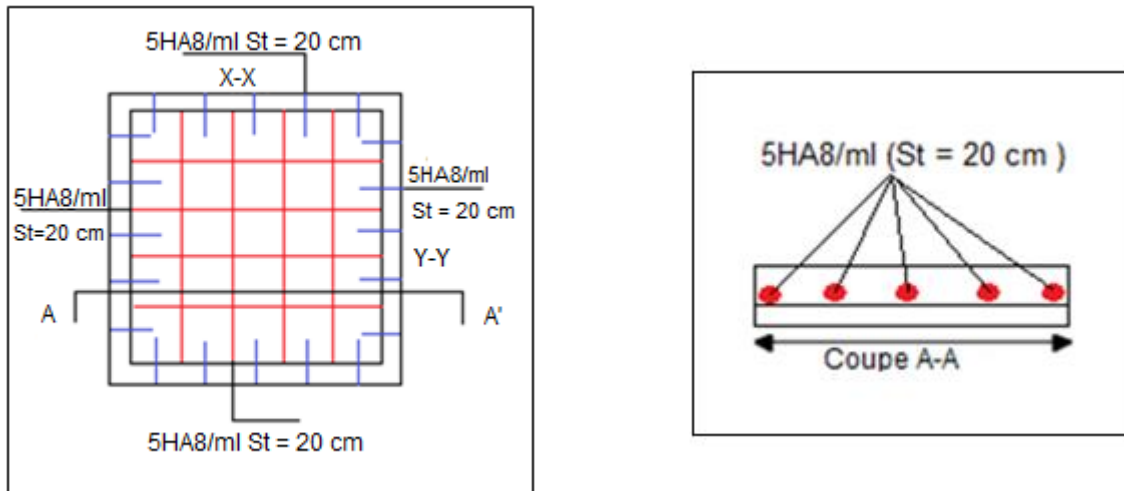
Schéma de ferrailage de la dalle d'ascenseur.
